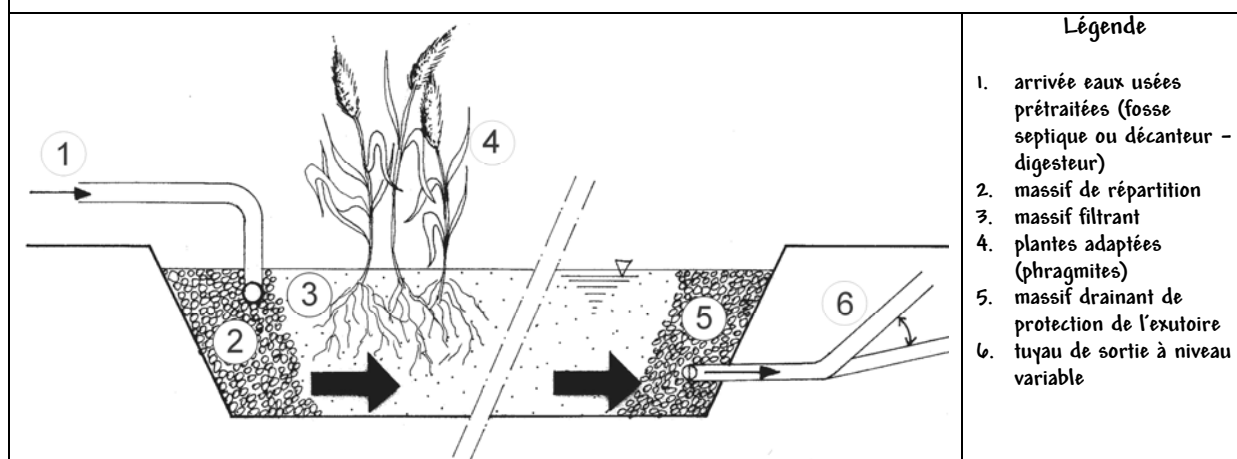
Illustration d'un filtre planté à écoulement horizontal
